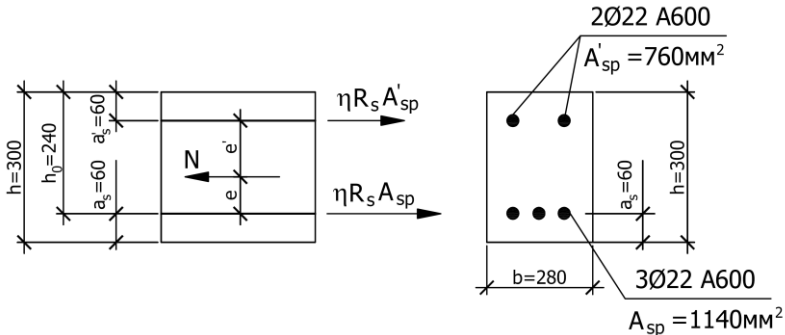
К подбору продольной арматуры в нижнем растянутом поясе
